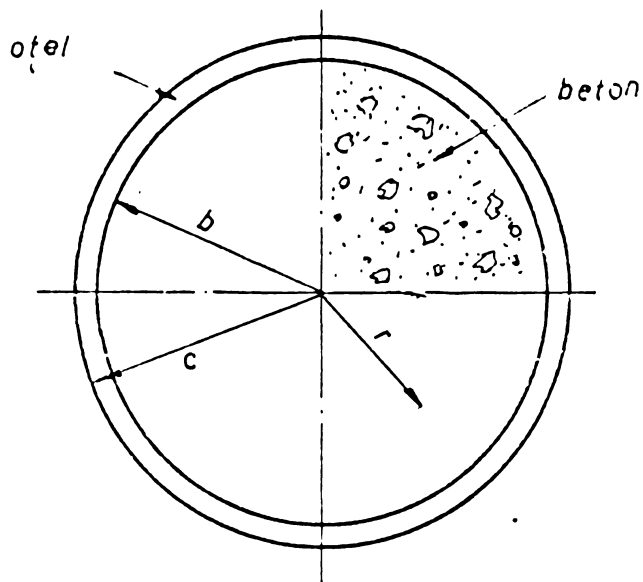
SECȚIUNE TRANSV. PRIN ŢEAVĂ, DIN OTEL UMPLUTĂ CU BETON.
